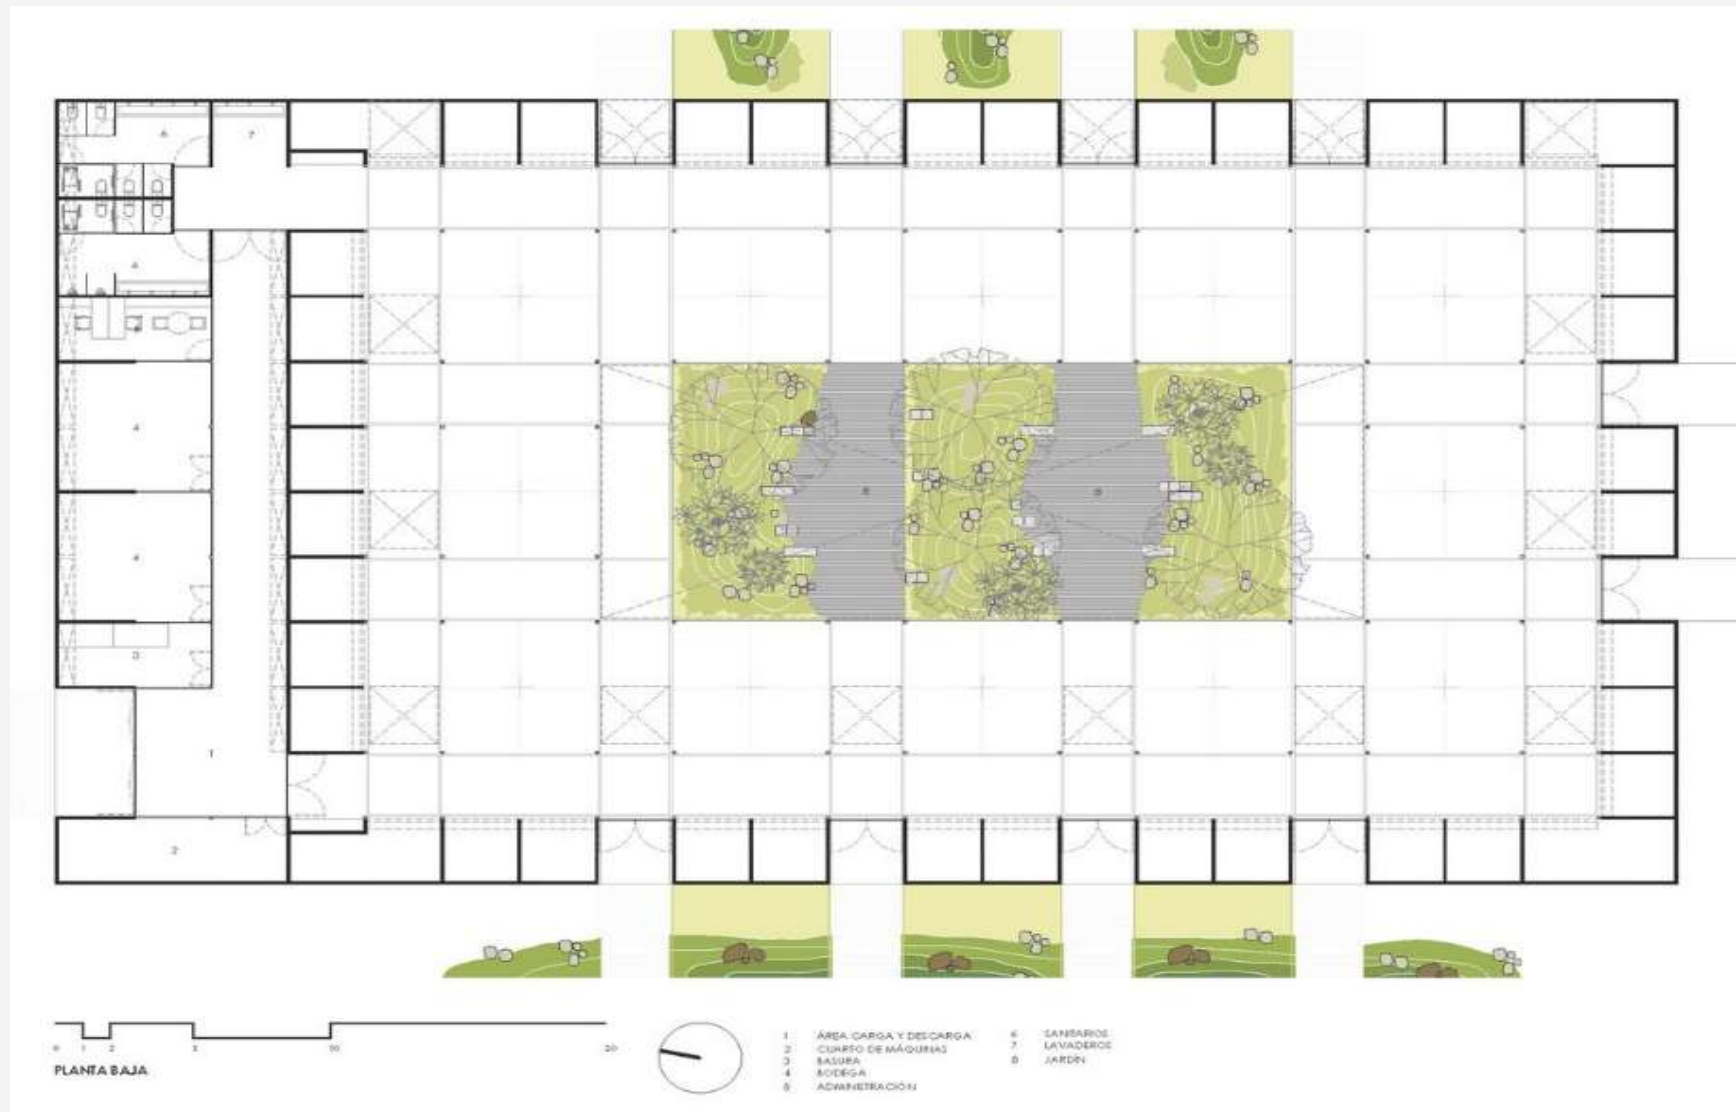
Planta baja del mercado público Matamoros. Fuente: ArchiDaily (2020)
